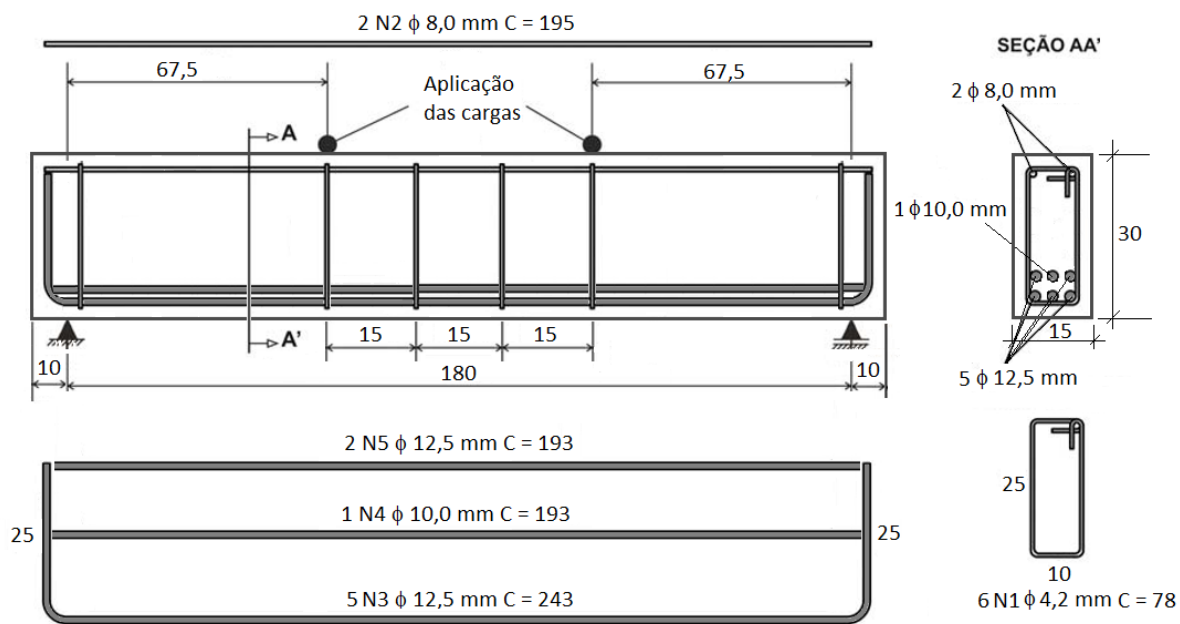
Esquema de detalhamento das armaduras das Vigas 1 para $a = 67,5$ cm, cotas em centímetros.
